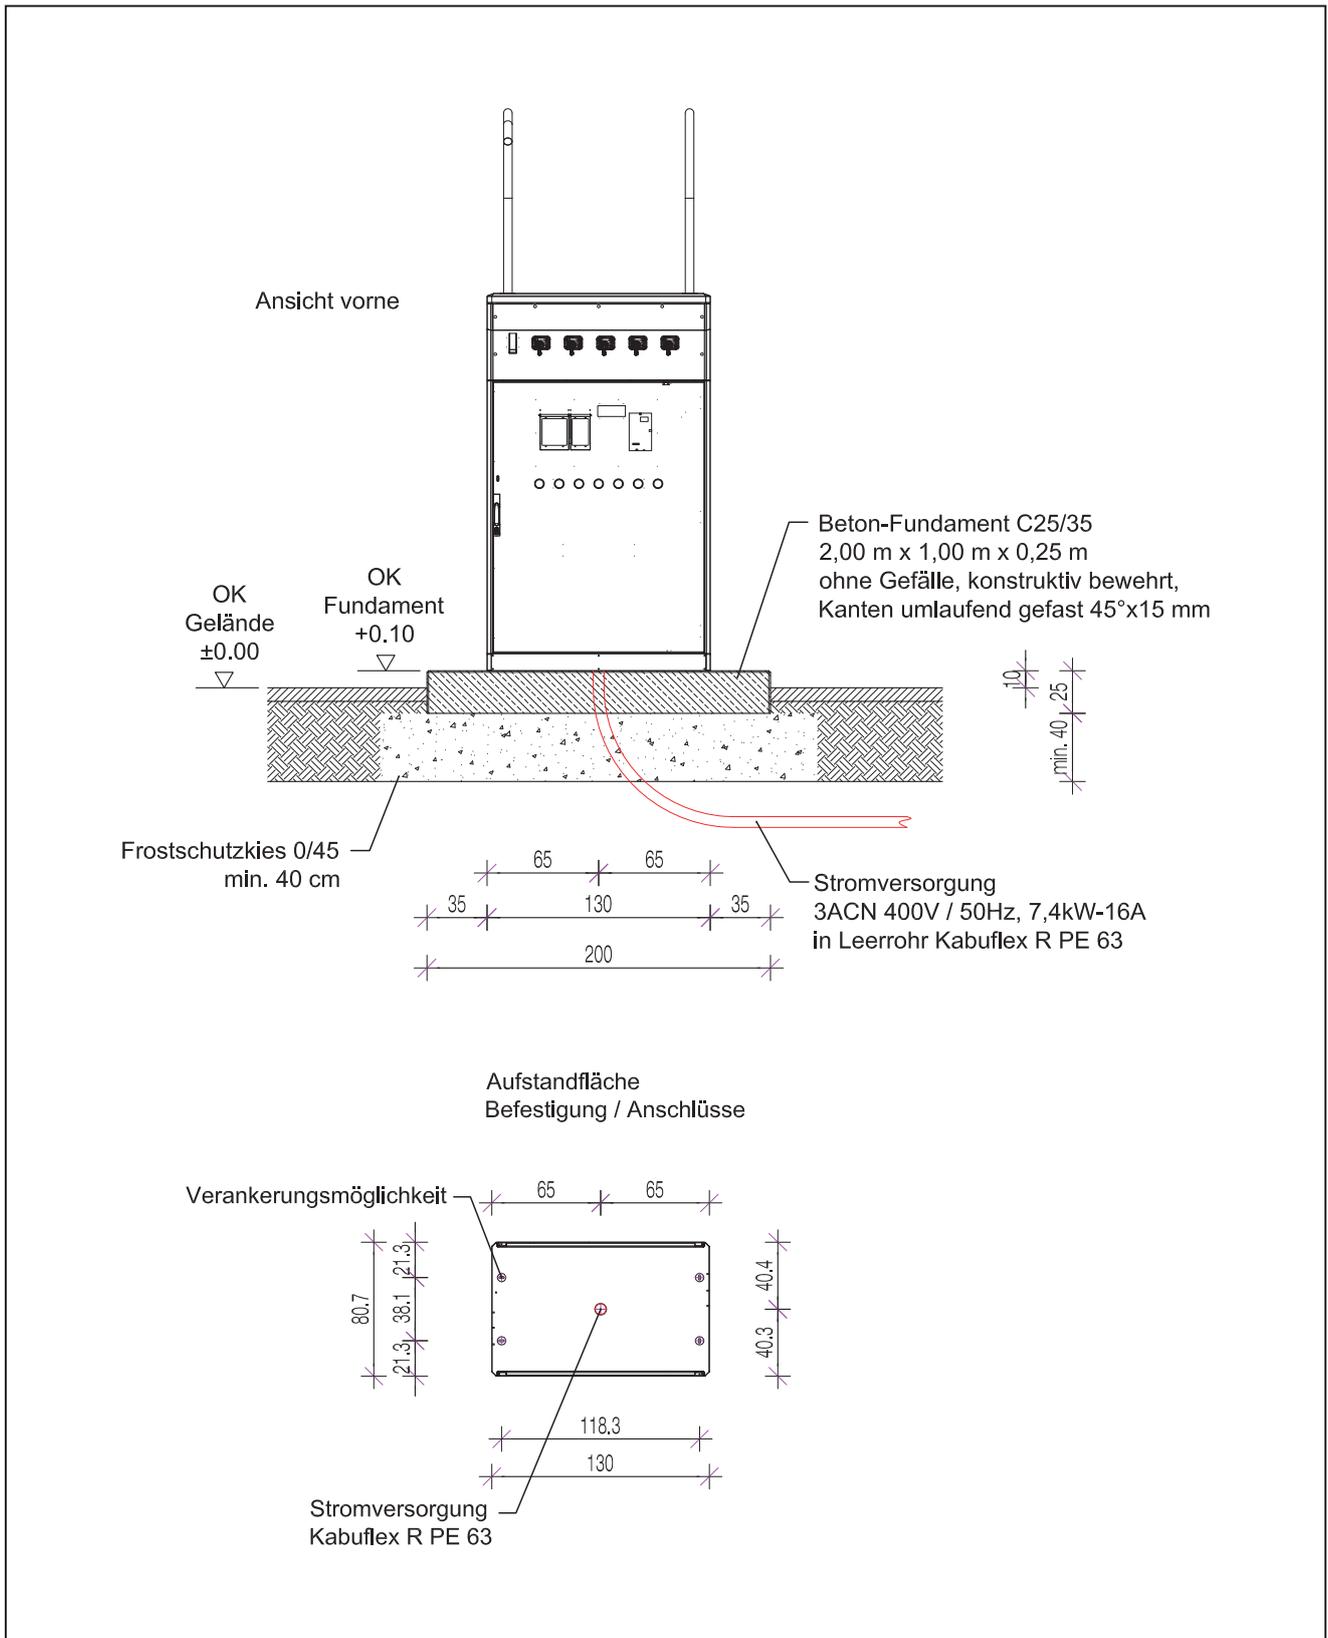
1 Bemaßung für Fundament, SB-MultiTerminal Frontansicht (allgemeines Beispiel)
